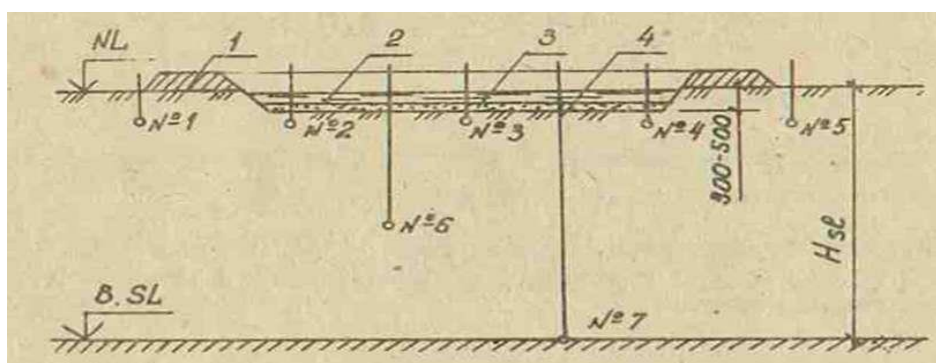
Схематический разрез котлована для опытного замачивания лессового грунта:
